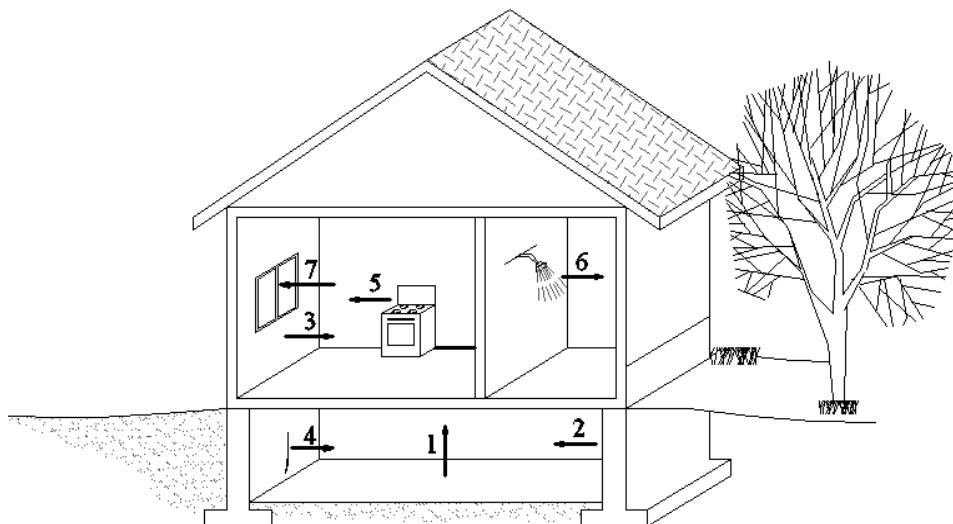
Основные источники и пути проникновения радона в здания: 1 - грунт под зданием; 2,3 – строительные материалы, применяемые при устройстве фундаментов и стен здания; 4 – трещины в конструкциях; 5 – система газоснабжения; 6 – система водоснабжения; 7 – выход радона [29]
